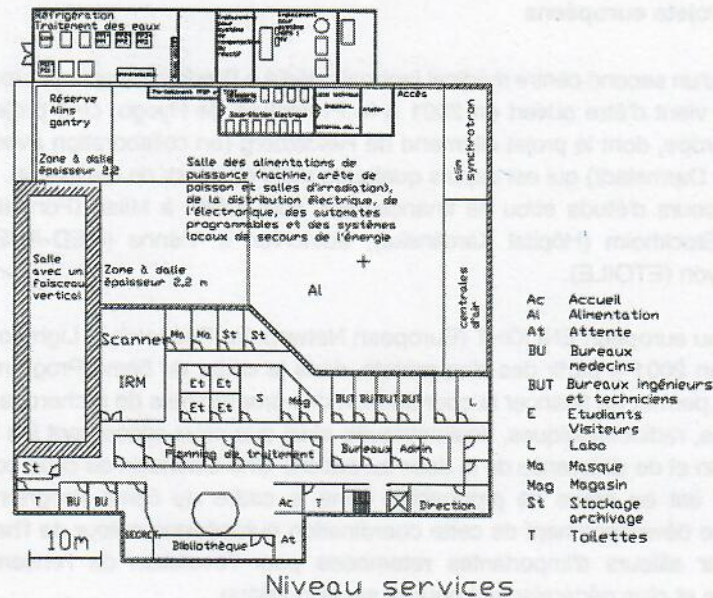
plan du niveau "services" du bâtiment ETOILE
